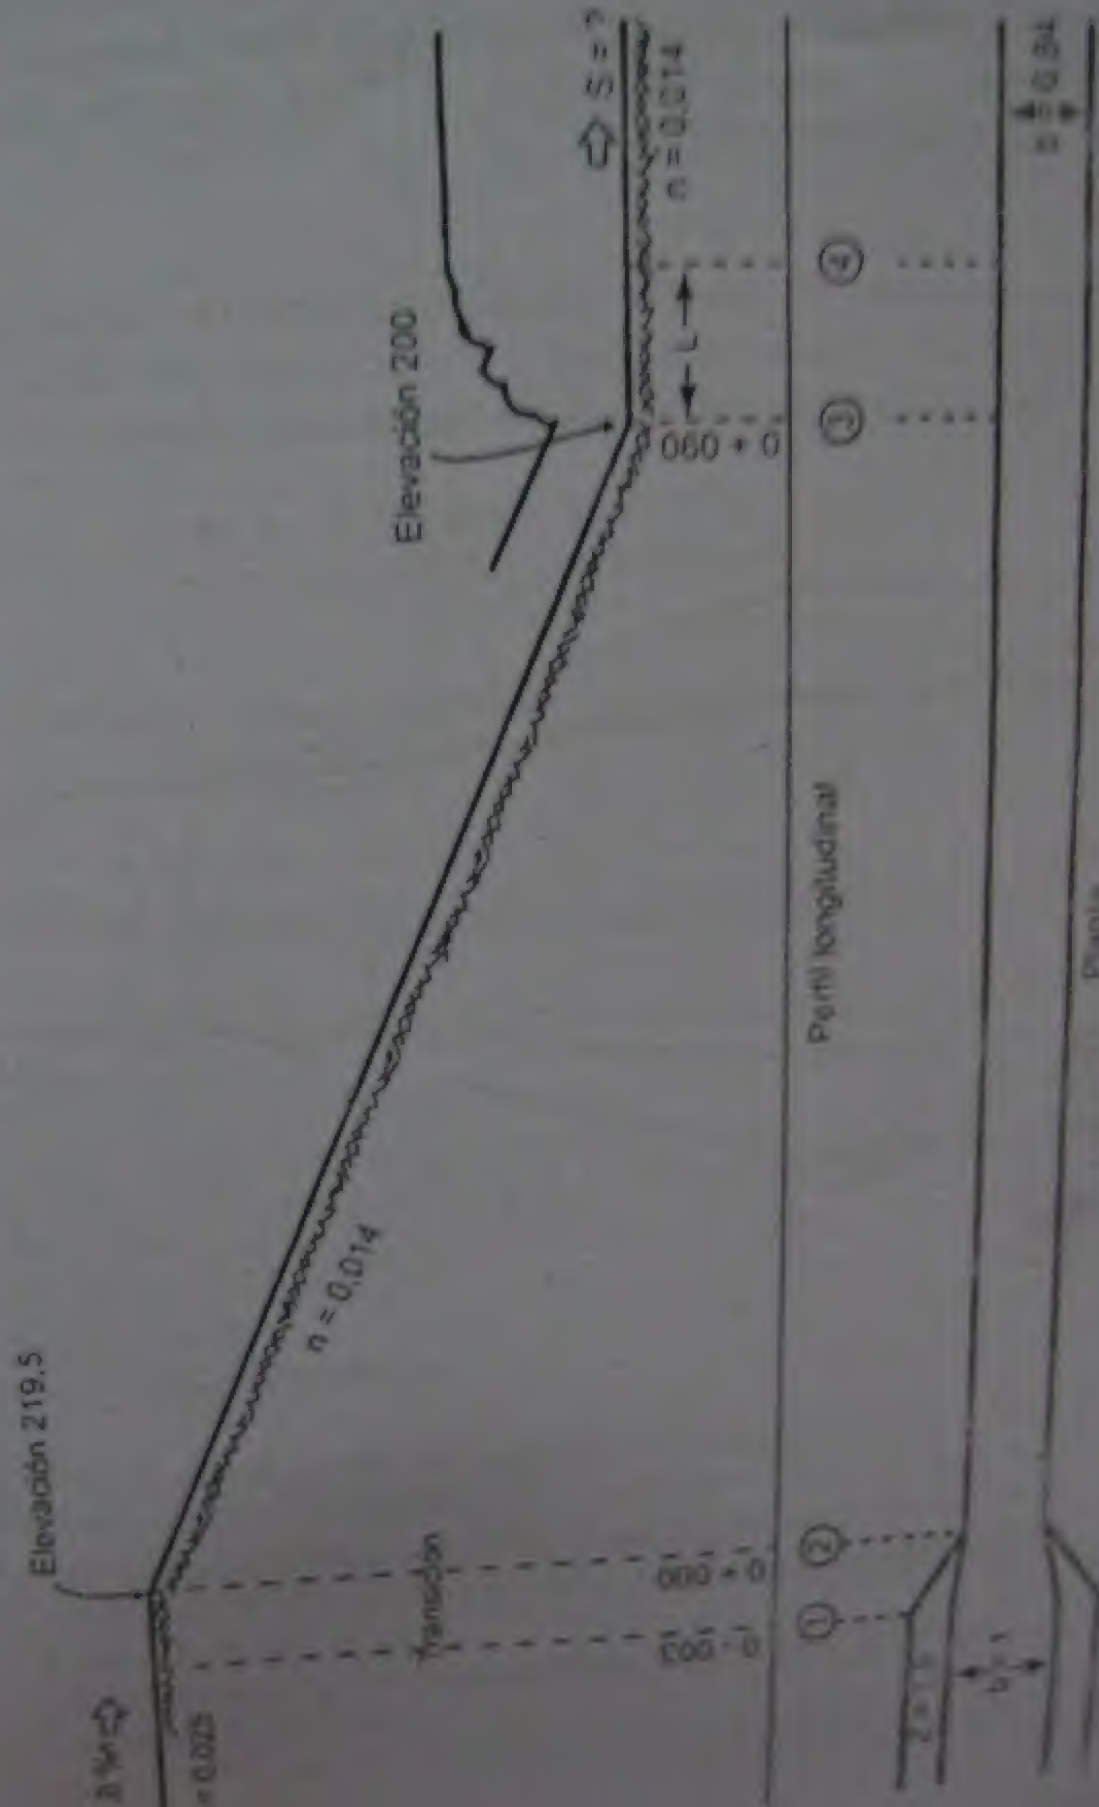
Perfil longitudinal y planta del régimen de un canal
